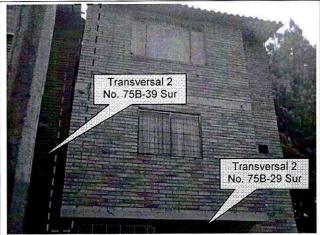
Se aprecia la separación en la junta de construcción de los muros de cerramiento de los predios con nomenclatura Transversal 2 No. 75B-29 Sur y Transversal 2 No. 75B-39 Sur Manzana 31 Lote 14 (UAECD).
